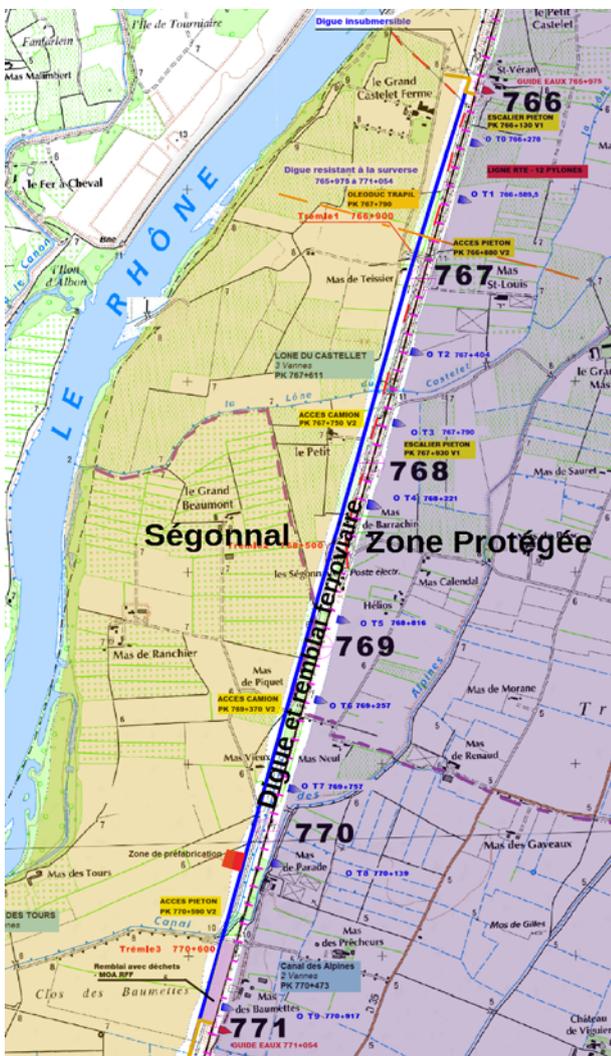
PLAN DE SITUATION DES TRAVAUX (SYSTRA).
